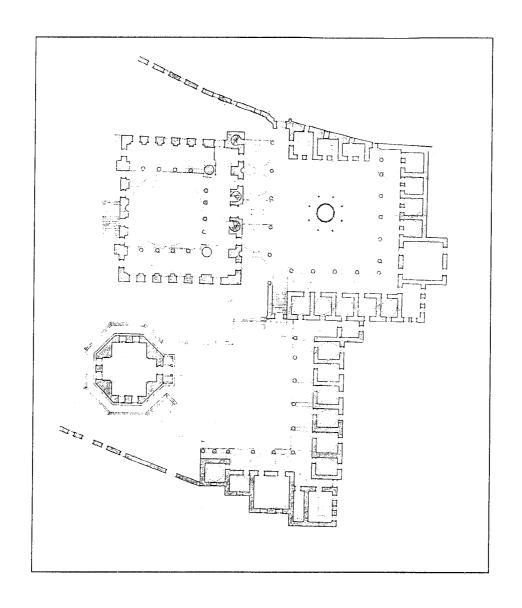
مسقط أفقي لمدرسة قابى اغاسى في اماسيا (عن: جابرييل).
